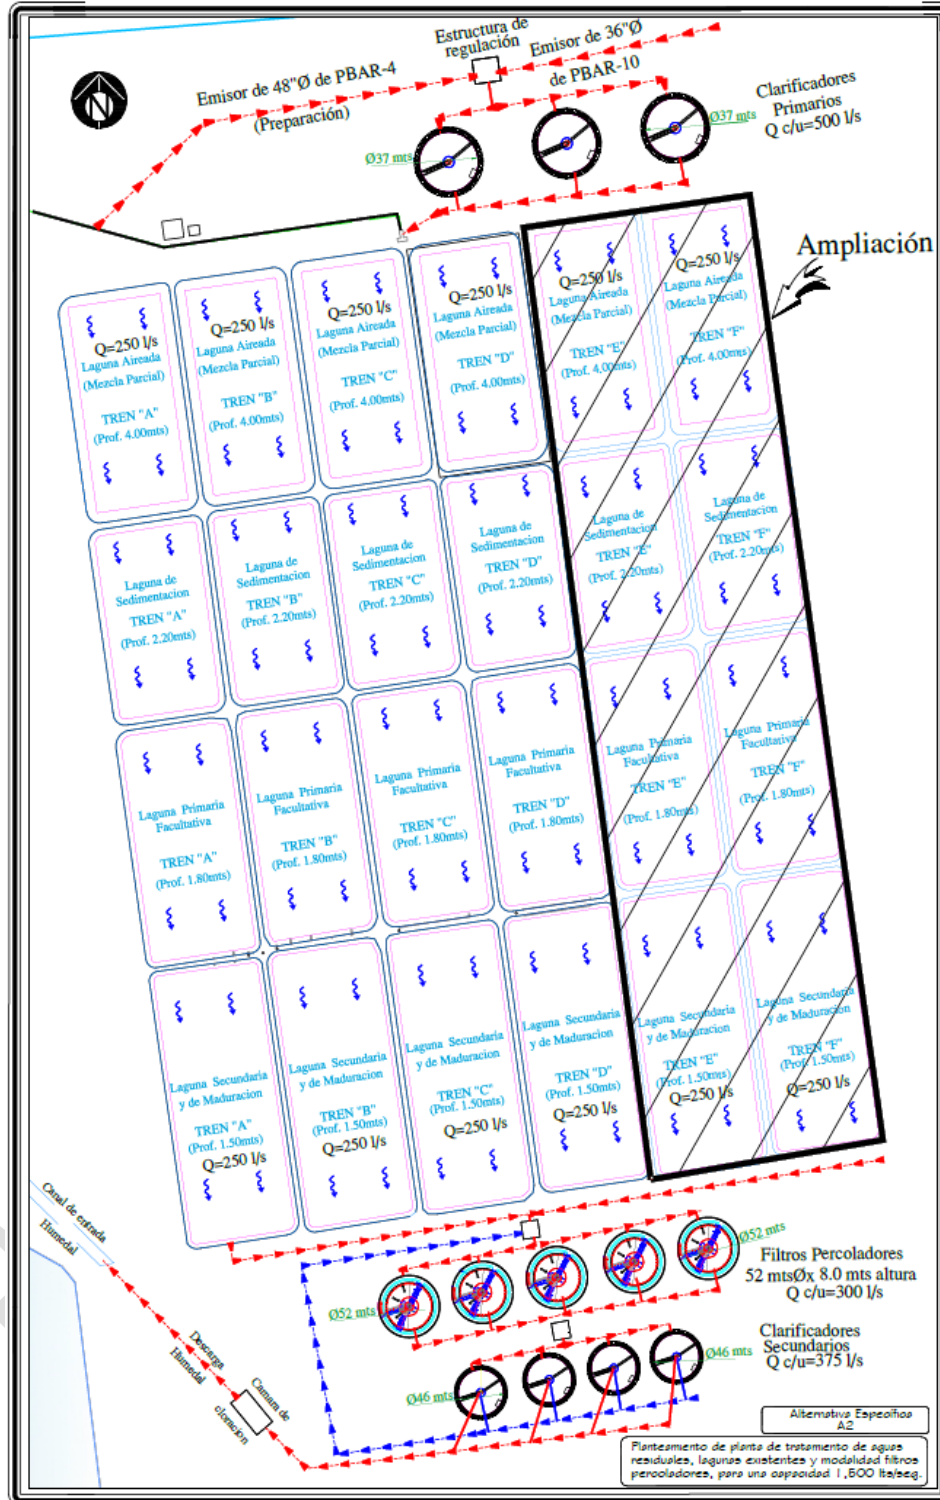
Alternativa A2. Reingeniería de la planta actual y ampliación de la capacidad de tratamiento hasta 1,500 L/s mediante una planta con filtros percoladores.
